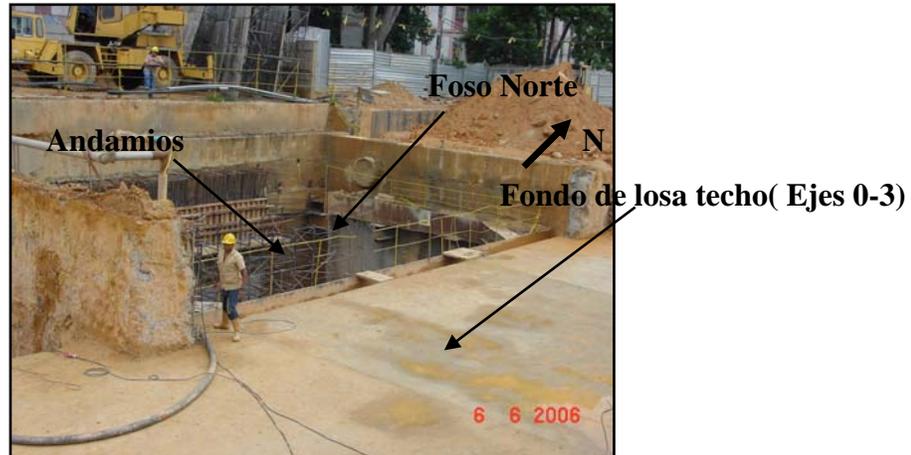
Cota inferior de la losa techo entre ejes 0-3.
